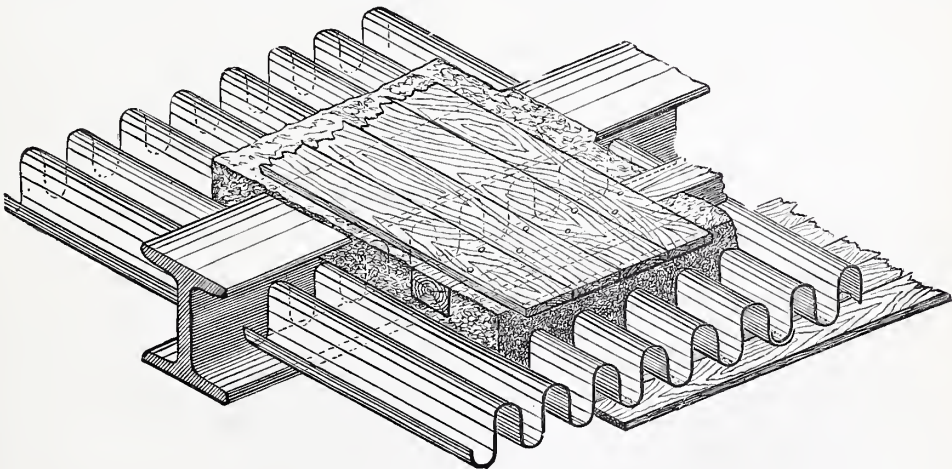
Decke mit Trägerwellblech auf I-Trägern.
